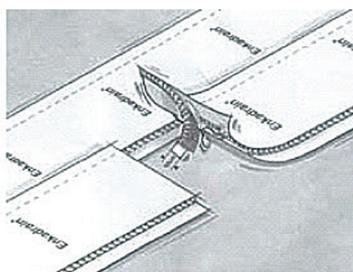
Обрезка рулона Enkadrain® при помощи строительного ножа или ножниц
